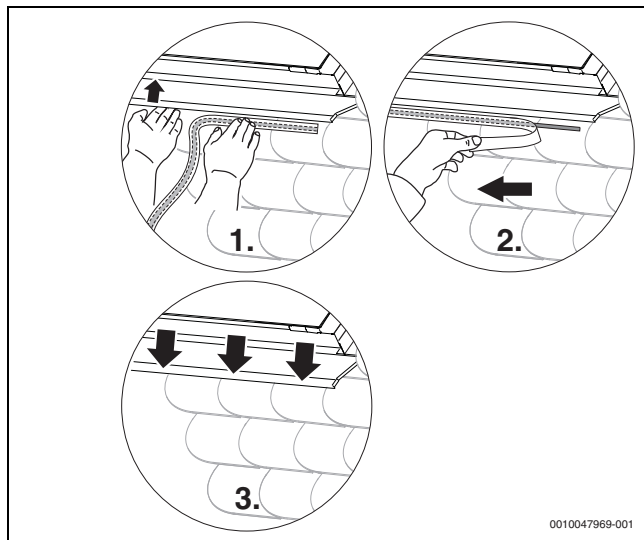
Unterer Eindeckblech auf Eindeckung kleben
